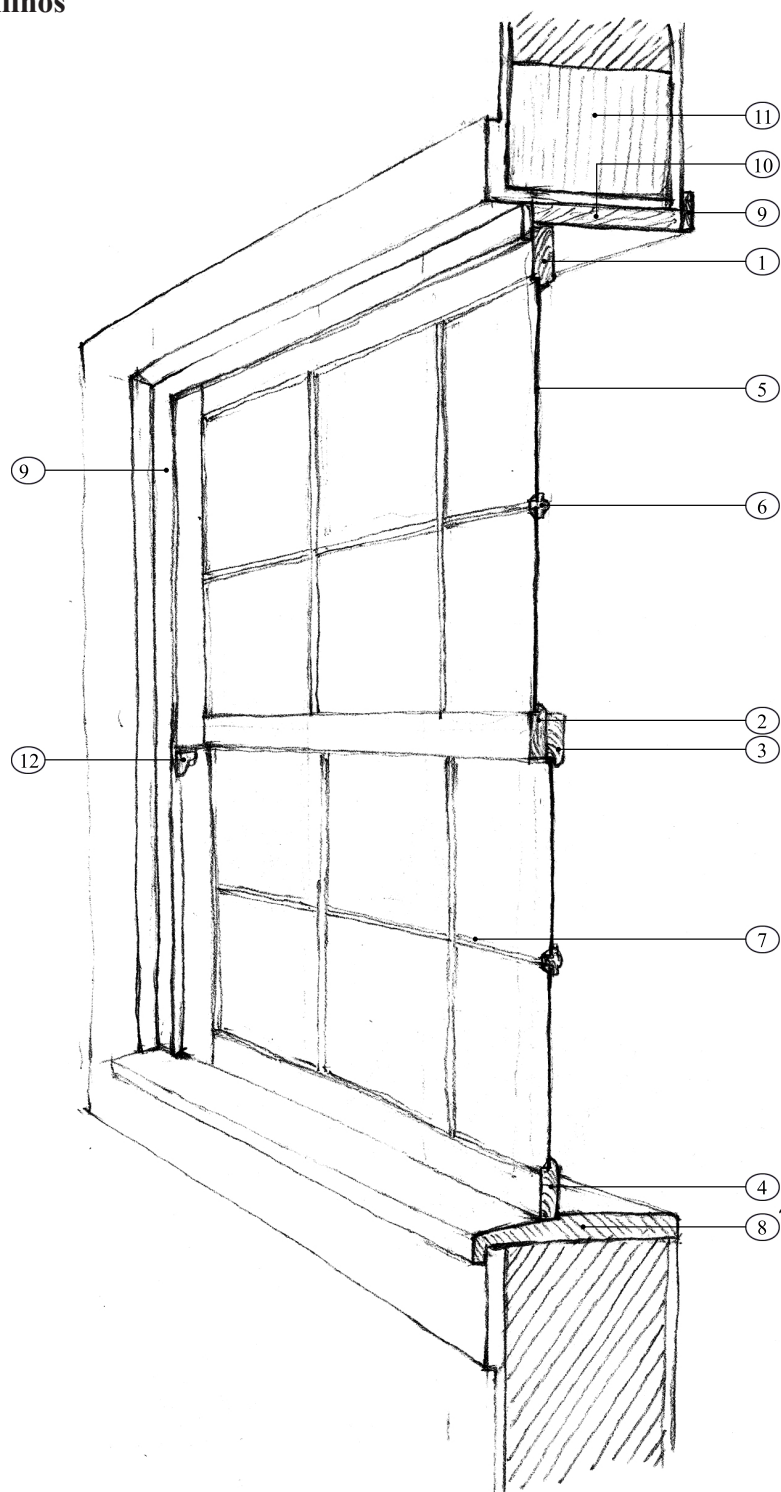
Corte tipo de um caixilho de janela de gilhotina. Legenda: 1 Travessa superior do caixilho fixo, 2 Travessa inferior do caixilho fixo, 3 Travessa superior do caixilho de abrir, 4 Travessa inferior do caixilho de abrir, 5 Vidro, 6 Pinázio, 7 Betume / Massa de vidraceiro, 8 Tábua de peito / Peitoril, 9 Alizare / Mata juntas, 10 Aro, 11 Pedra de lintel do vão, 12 Orelhas em metal.
